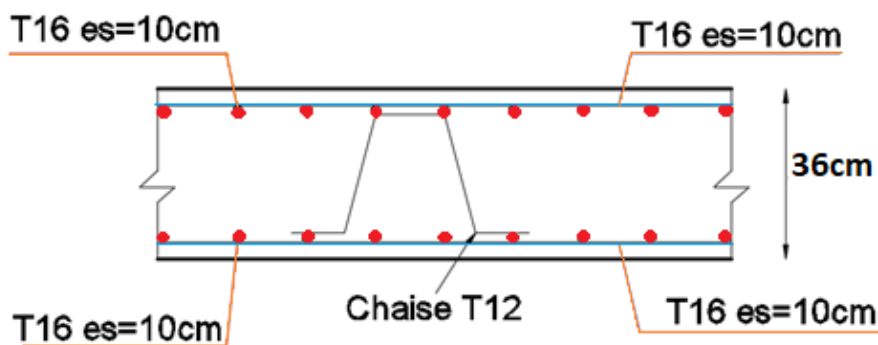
Schéma de ferrailage de la dalle du radier sur appuis.
